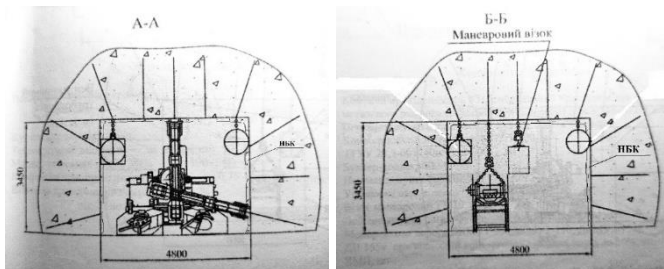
Перетини виробки прямокутної форми з анкерно-набризкбетонним кріпленням
